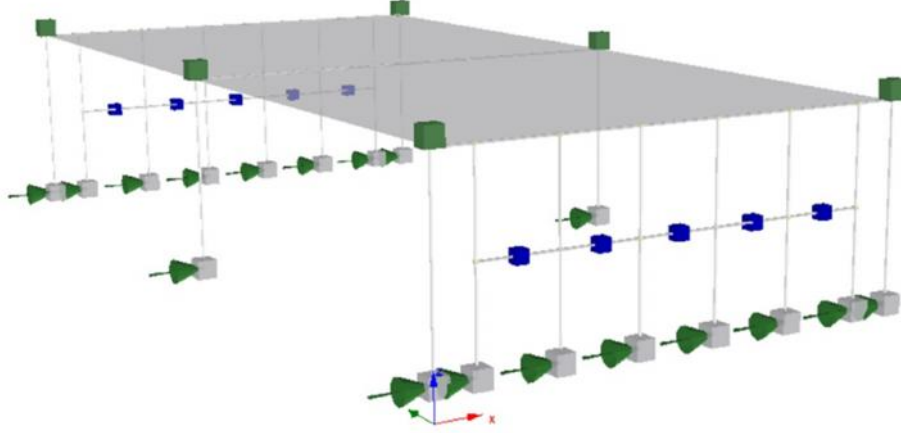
İki açıklıklı prefabrik yapıda tip-2 panellerin dizilişi.
